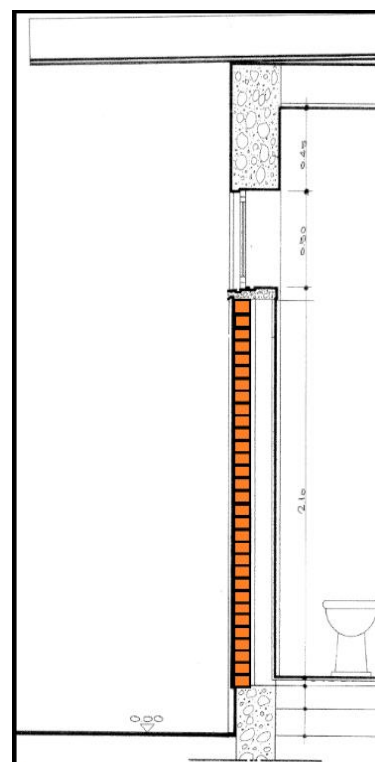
Corte de parede exterior de sanitário (P.E 2)
